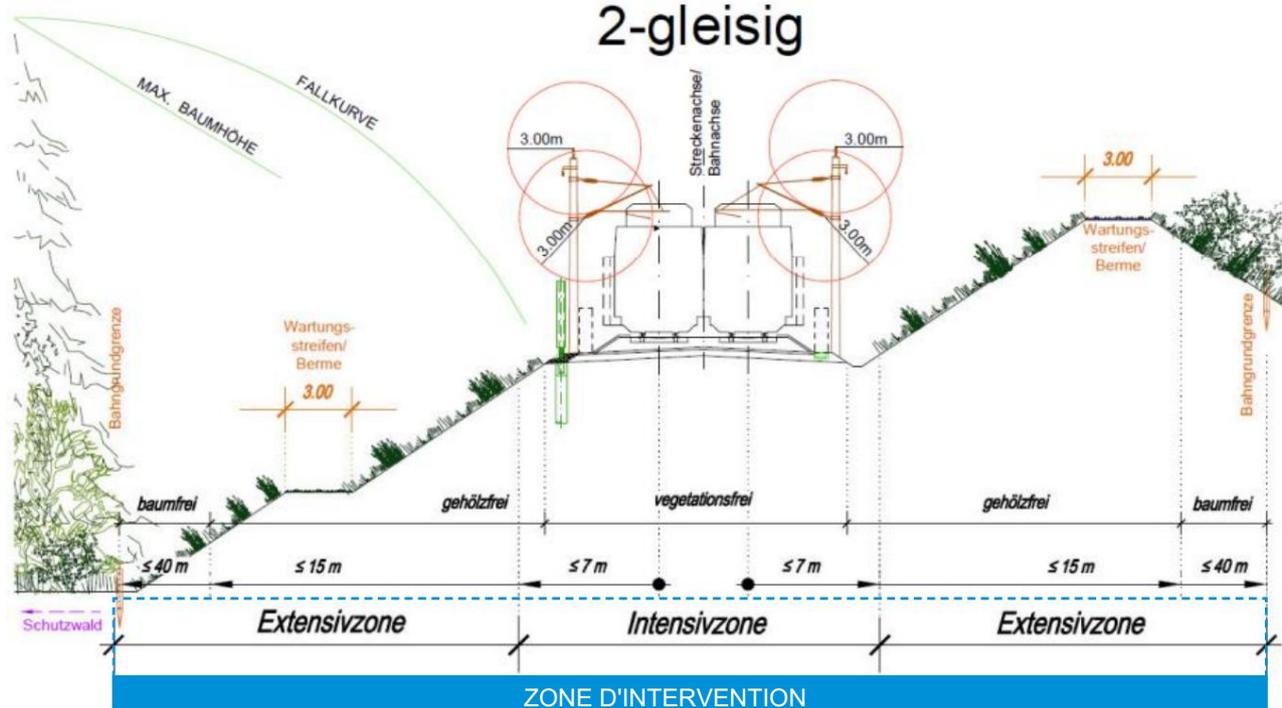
Coupe latérale de la voie ferrée ÖBB – nouvelle ligne à double voie construite, avec remblai de protection contre le bruit
